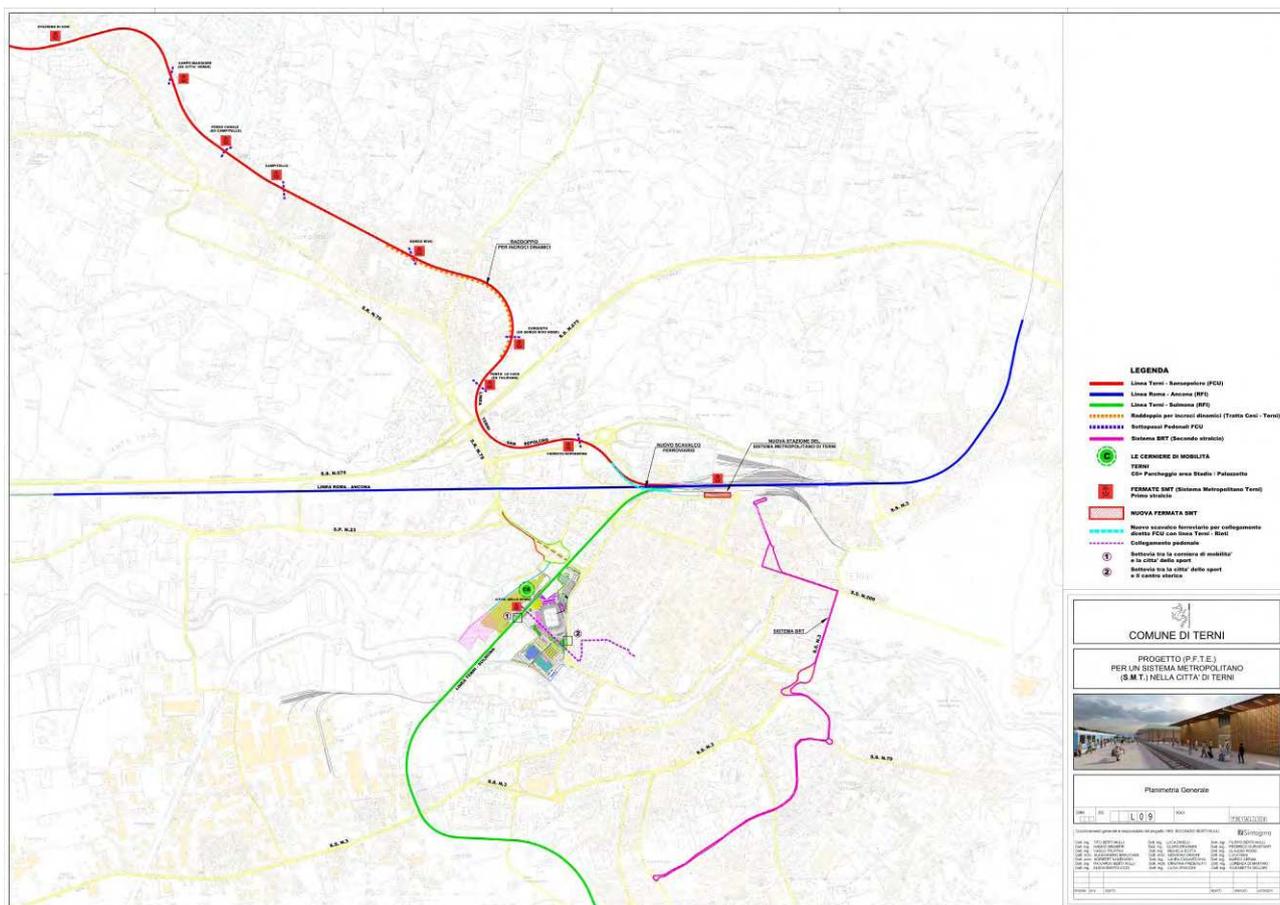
PROGETTO (P.F.T.E.) PER UN SISTEMA METROPOLITANO (S.M.T.) NELLA CITTA' DI TERNI – Planimetria Generale
